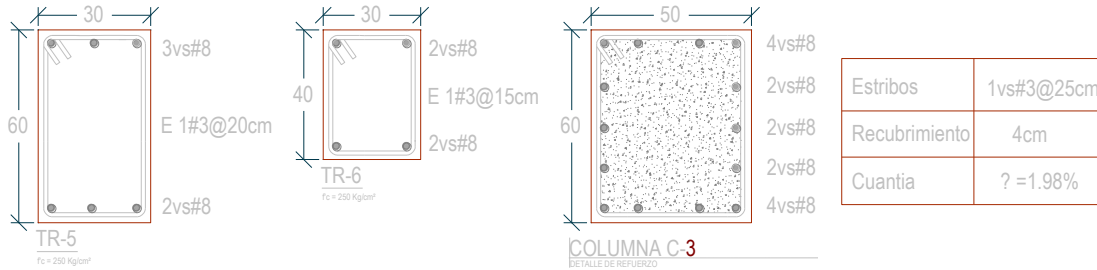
Secciones transversales de edificios diseñados con NTCC-77 (con interacción suelo-estructura y con base fija)
